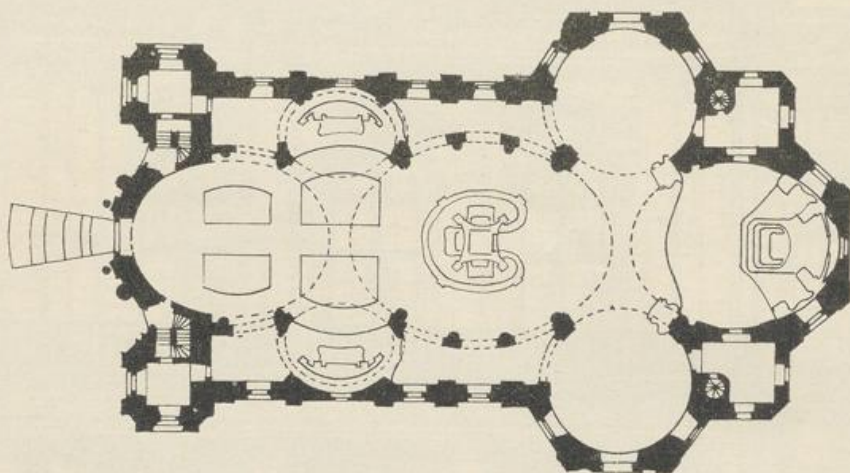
Grundriss der Kirche zu Vierzehnheiligen
